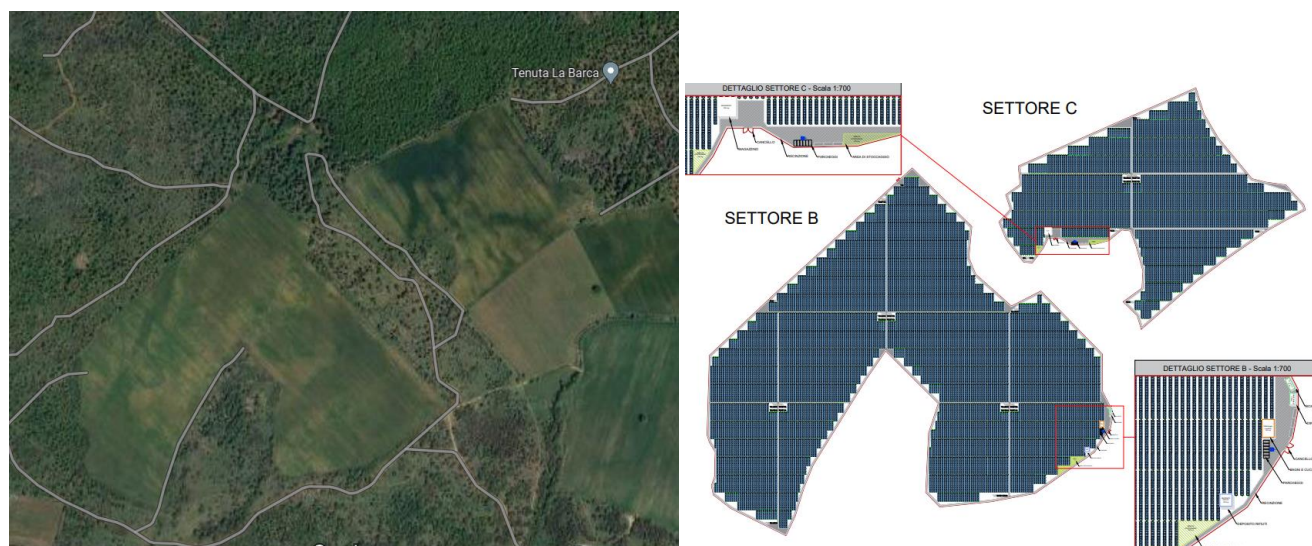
Ortofoto dell'area interessata dai settori B e C di progetto (a sinistra) planimetria del layout dei pannelli nei settori B e C di progetto e dettaglio di alcune porzioni perimetrali (cfr. elab FV_MUS01_CV04-00)
